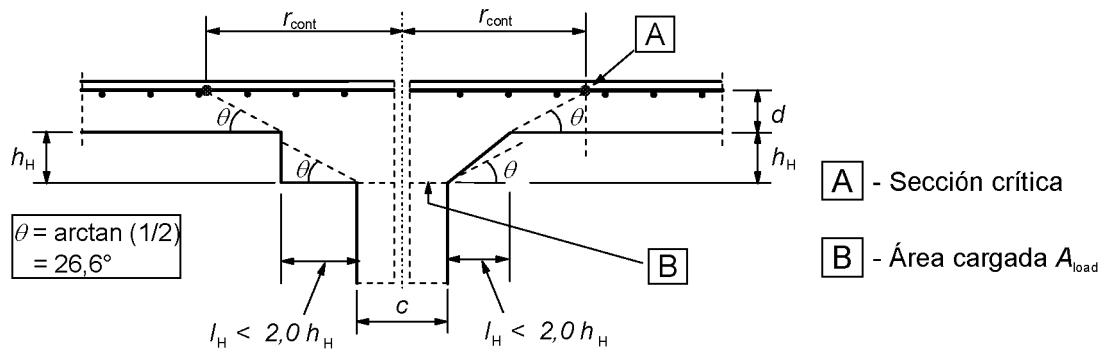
Losa con pilar con capitel, con $l_H < 2,0 h_H$
